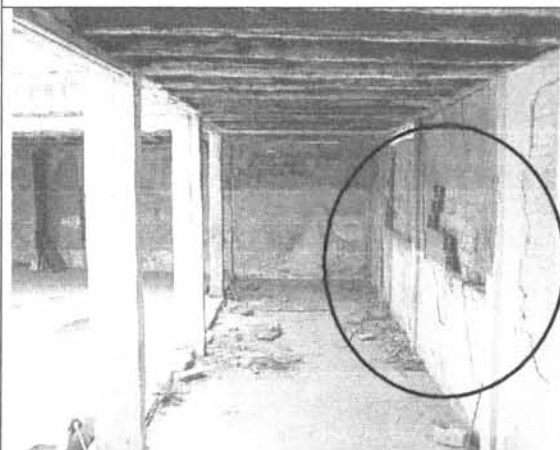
Agrietamiento de muros y deterioro progresivo de la edificación
